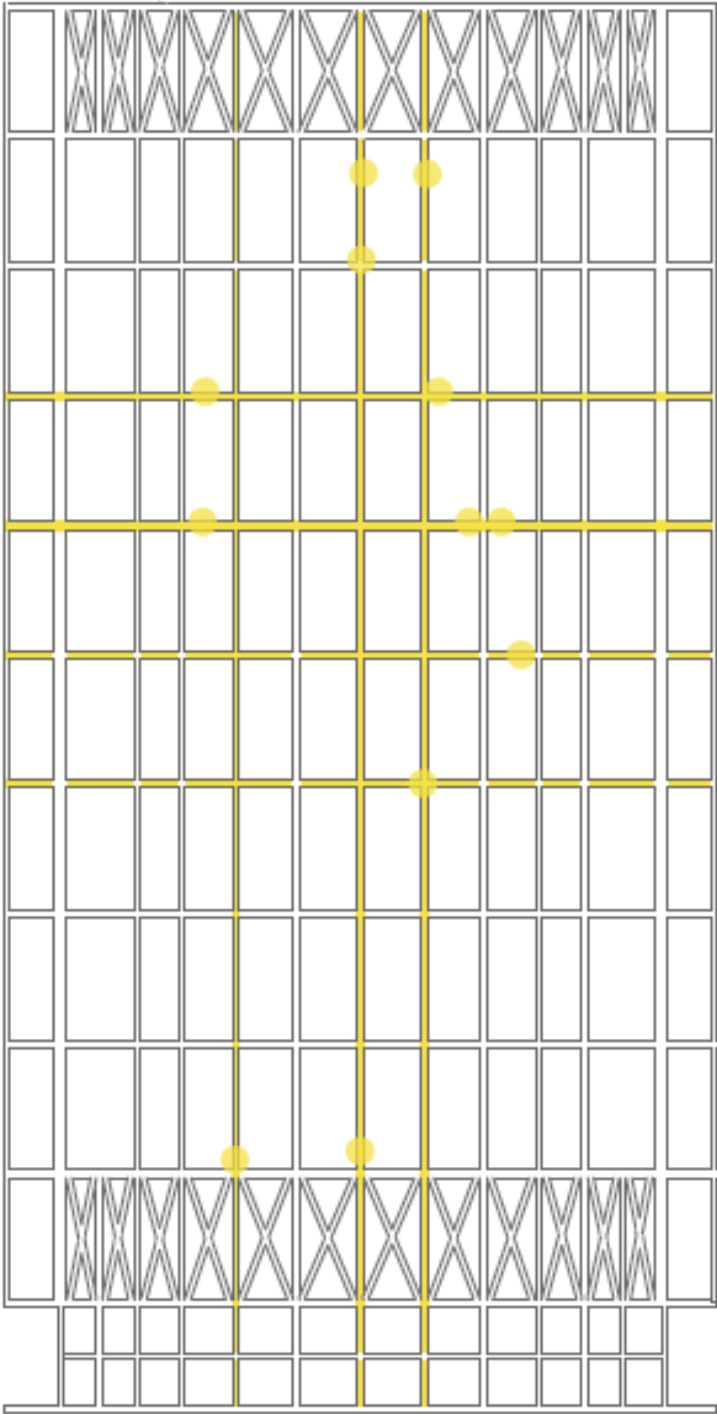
Planta esquemática de corrosión leve y grave en vigas y arcos de la nave central del mercado. (elaboración propia)
